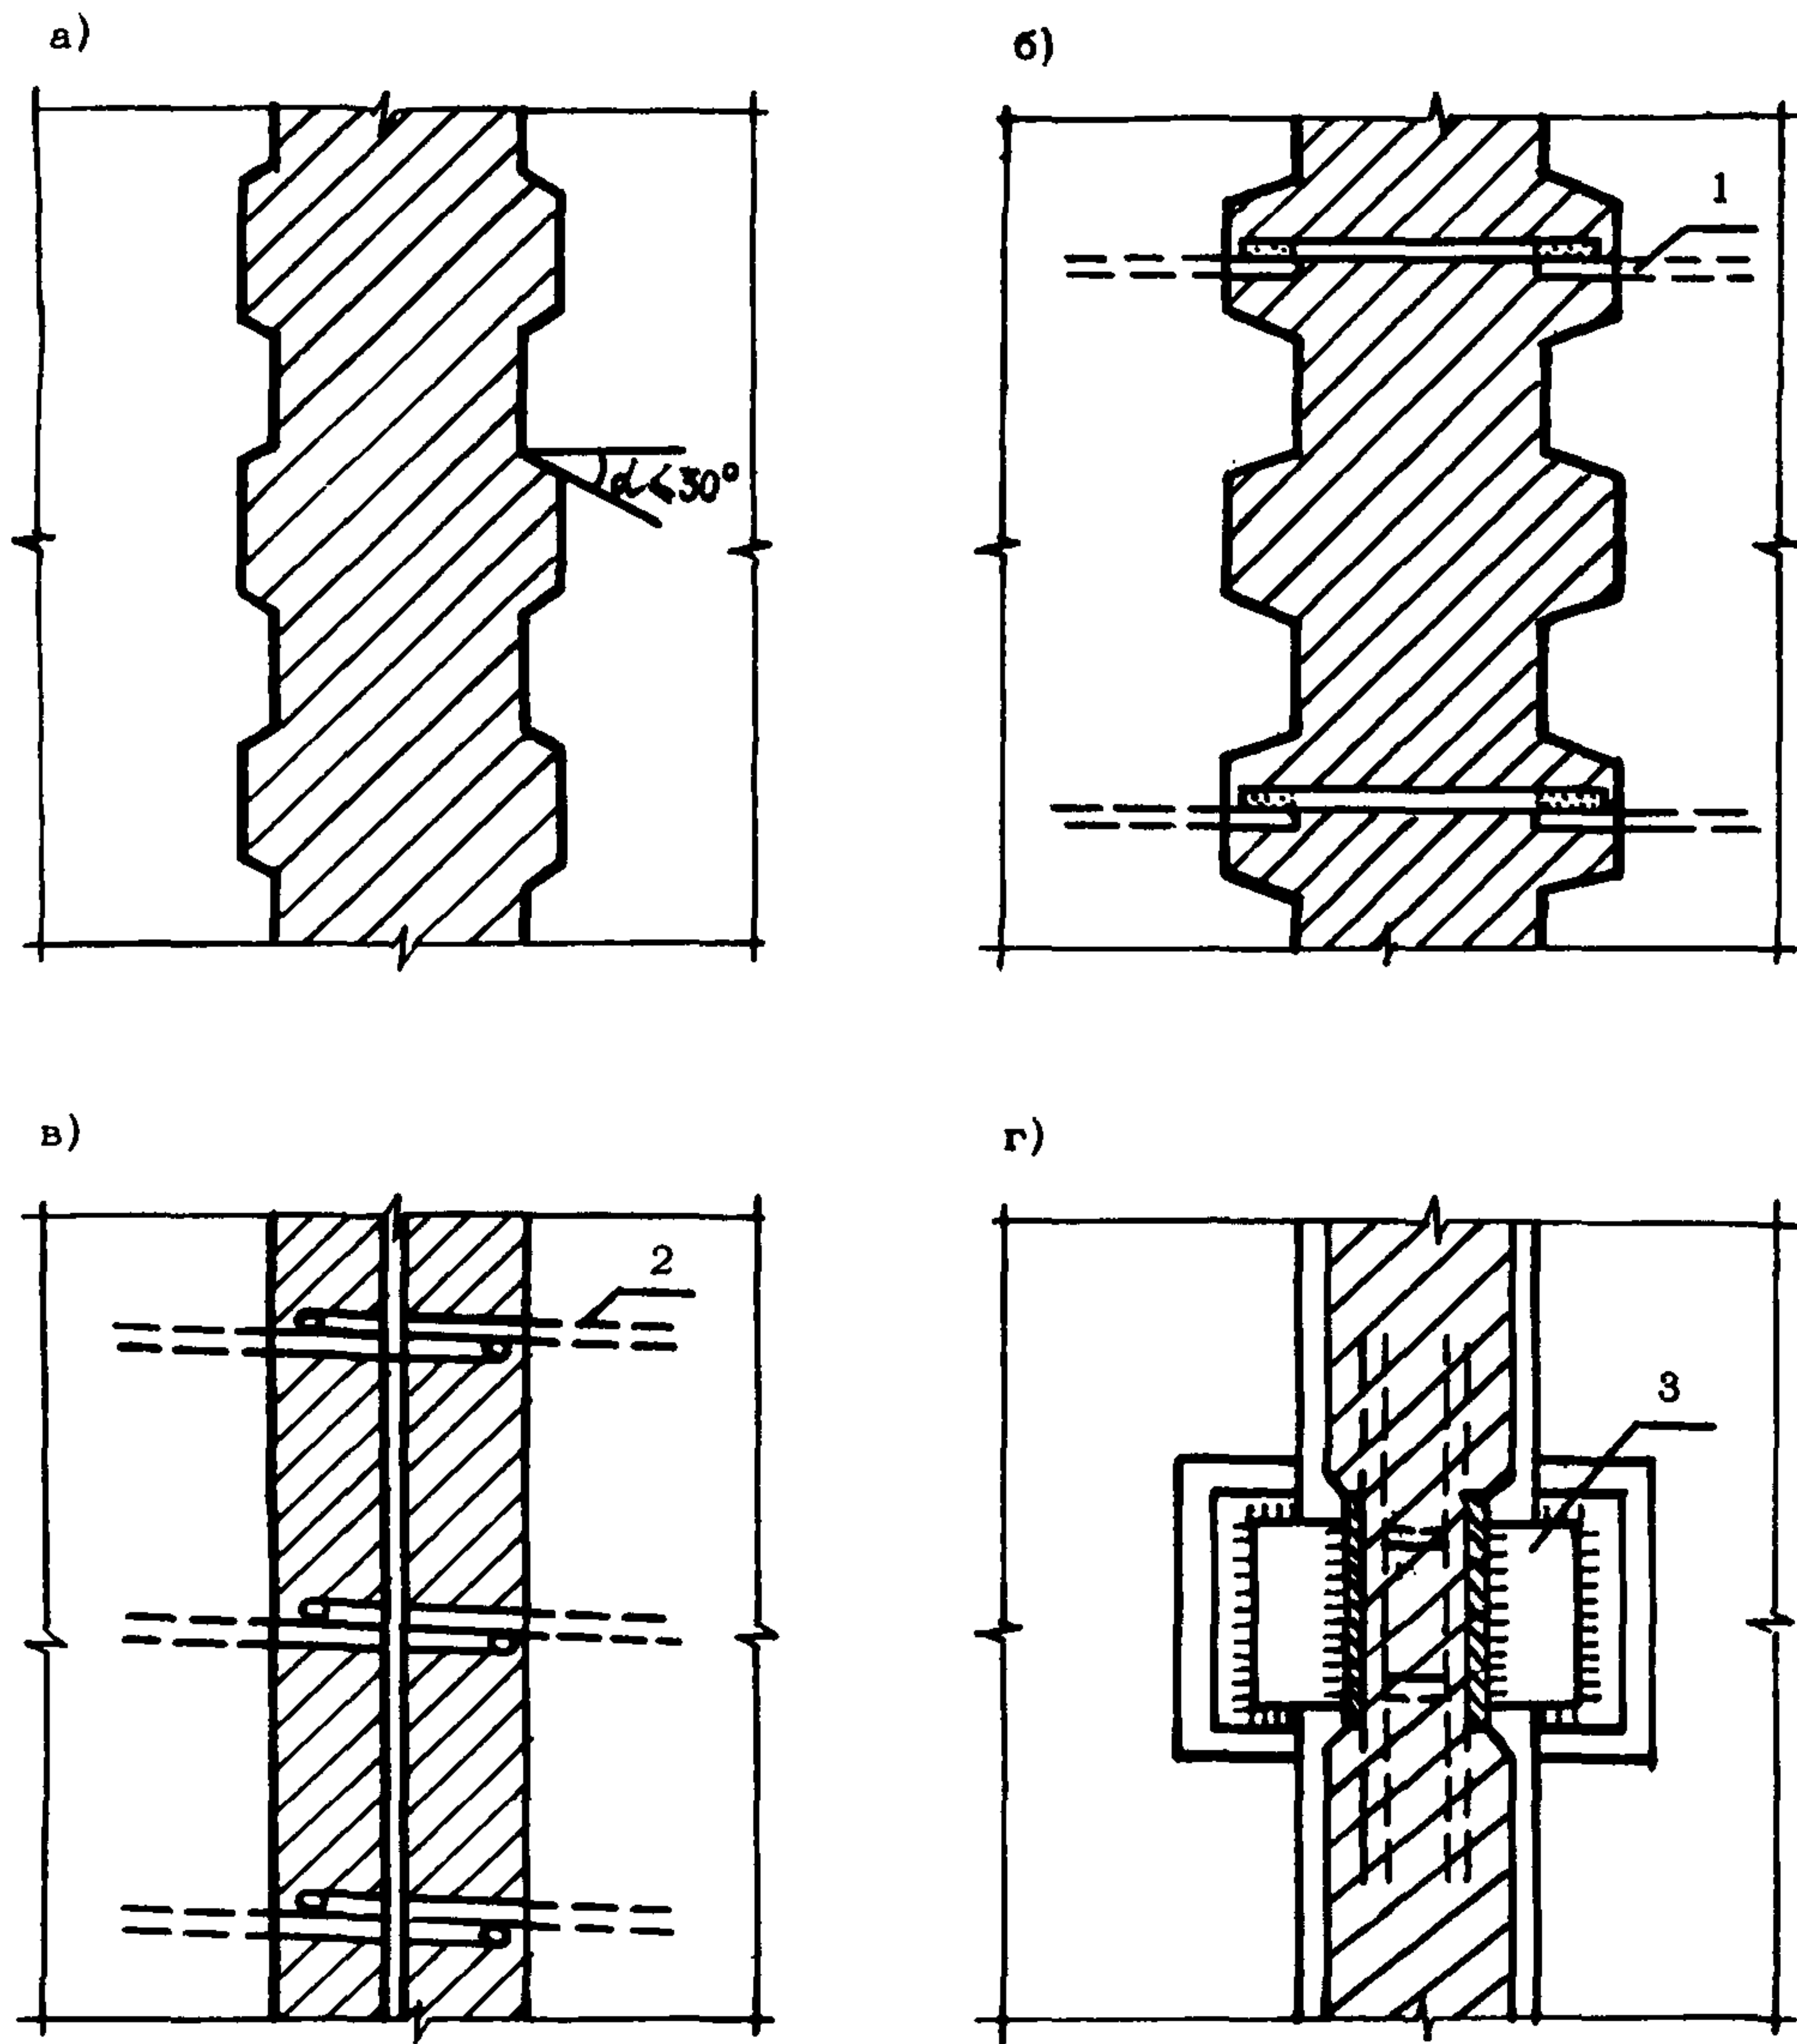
Типы соединений стеновых панелей в вертикальных стыках: а – шпоночное бетонное; б – шпоночное железобетонное; в – бесшпоночное петлевое; г – сварное на закладных деталях; 1 – сварная связь; 2 – петлевая связь; 3 – накладка, приваренная к закладным деталям в панелях
